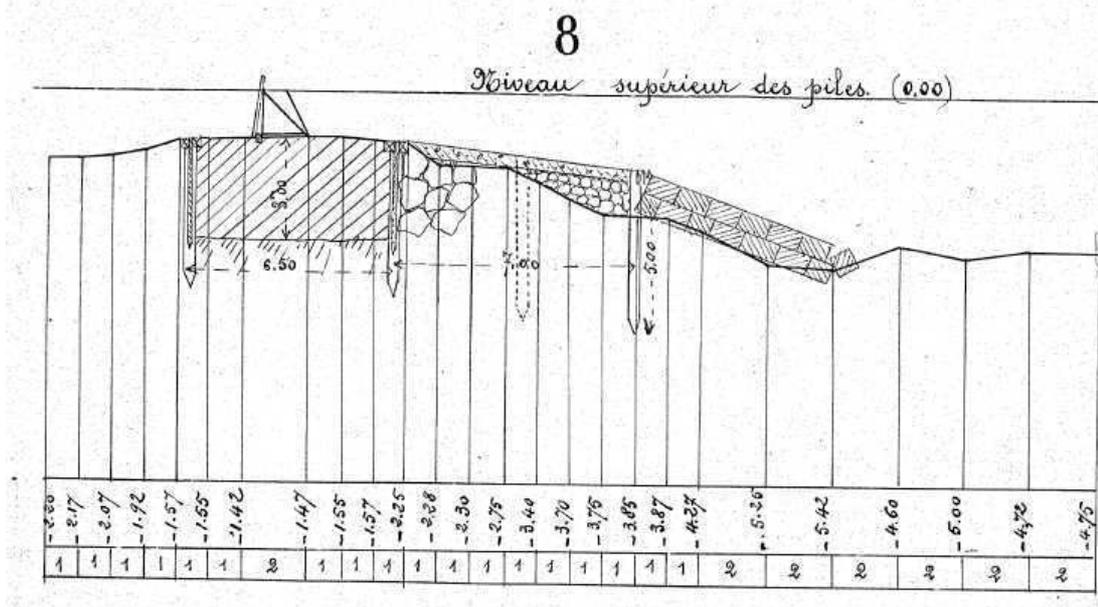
Profil au niveau des passes supérieures (avec dalle béton sur le parement aval), 1906 [2]
